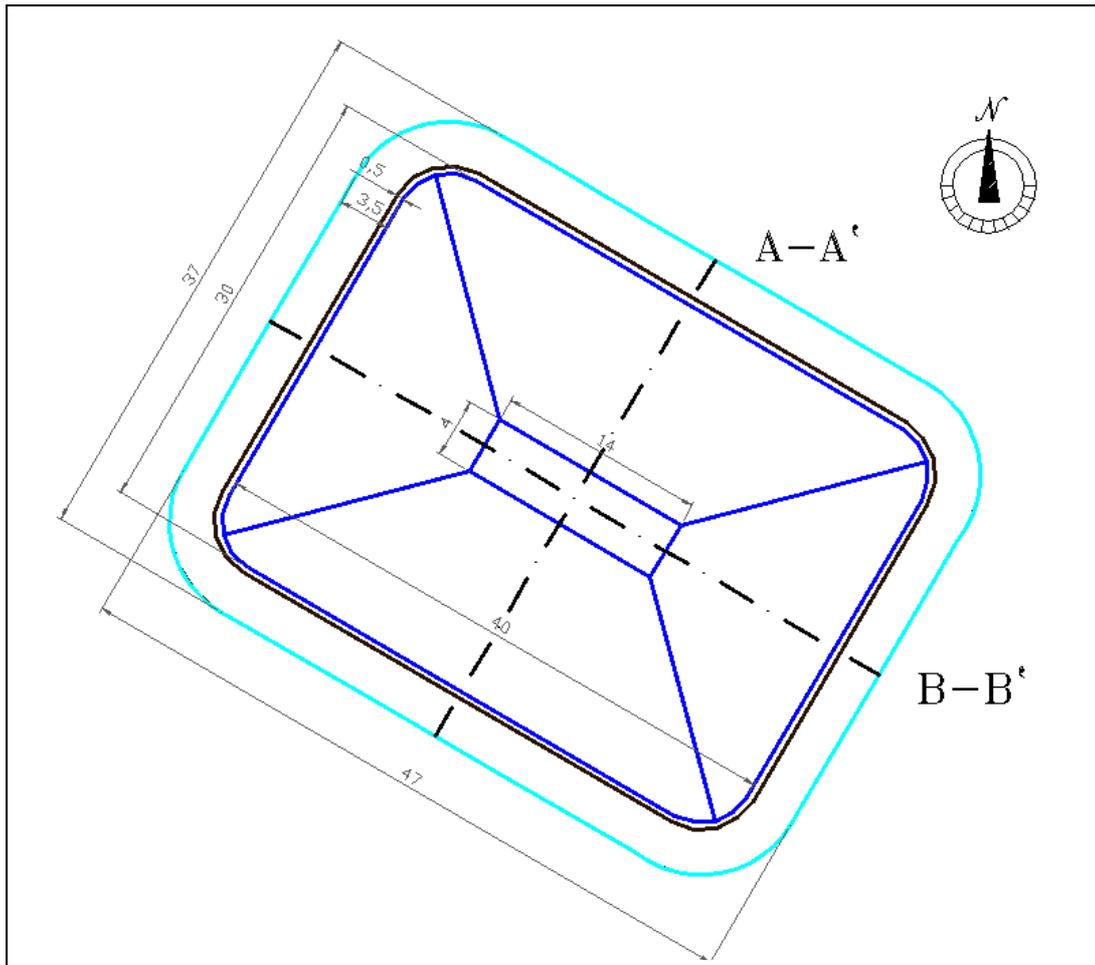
Dimensiones de la balsa. Vista en planta. Cotas en metros. S/E..
